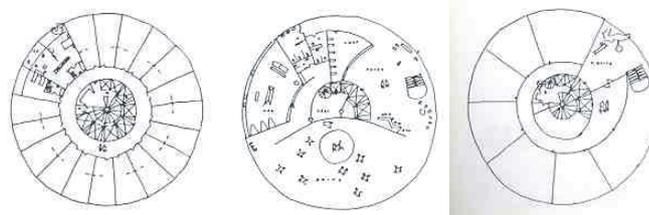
Hotel Nacional, Rio de Janeiro, 1970. Planta Baixa. Oscar Niemeyer.
